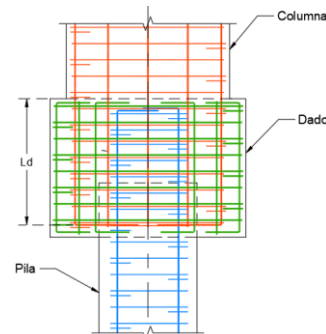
b – Conexión entre columna y cabezal o dado de pila
